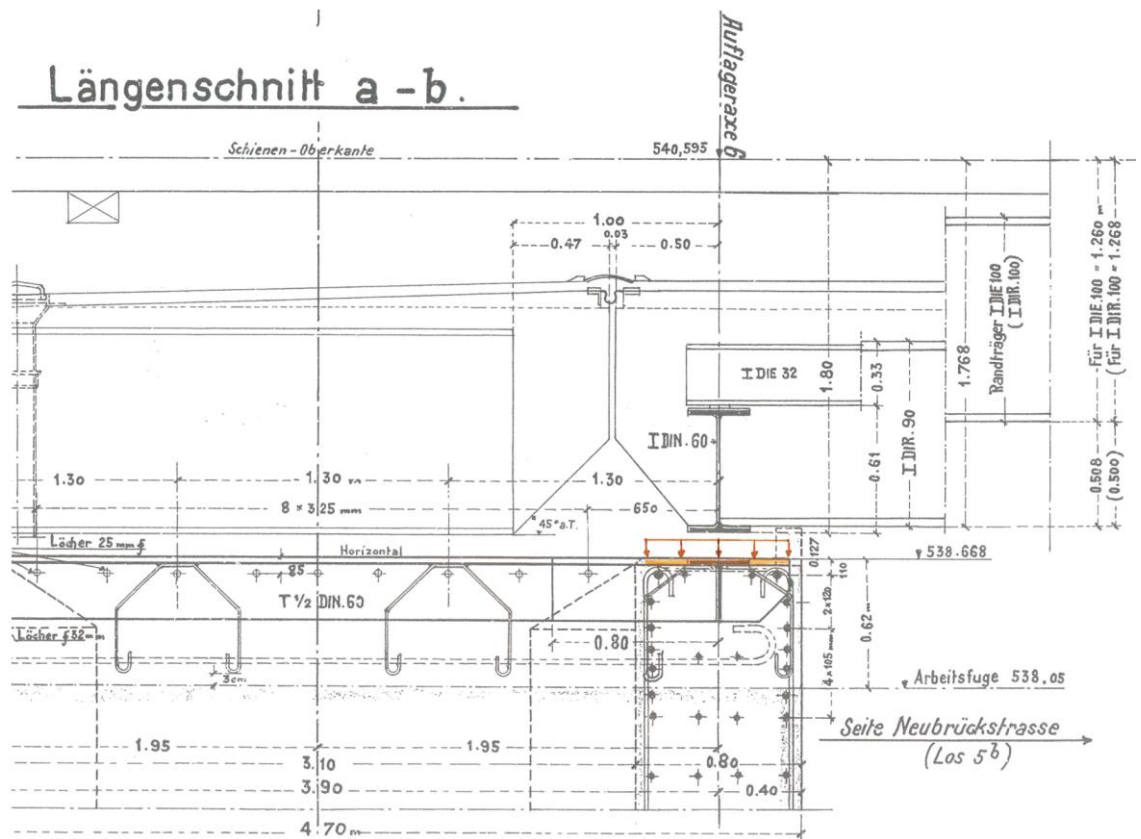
Längsschnitt des Auflagerrahmens im massgebenden Eck des Brückenpfeilers (Ausschnitt aus Plan 17.104-13)
